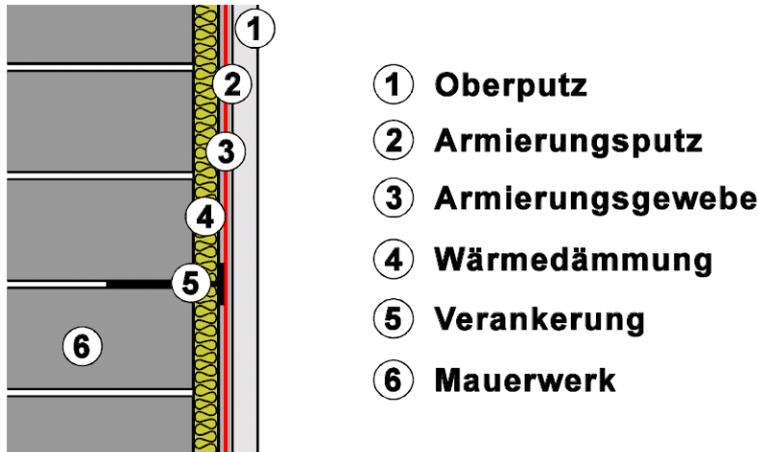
Aufbau eines Wärmedämmverbundsystems [1]
